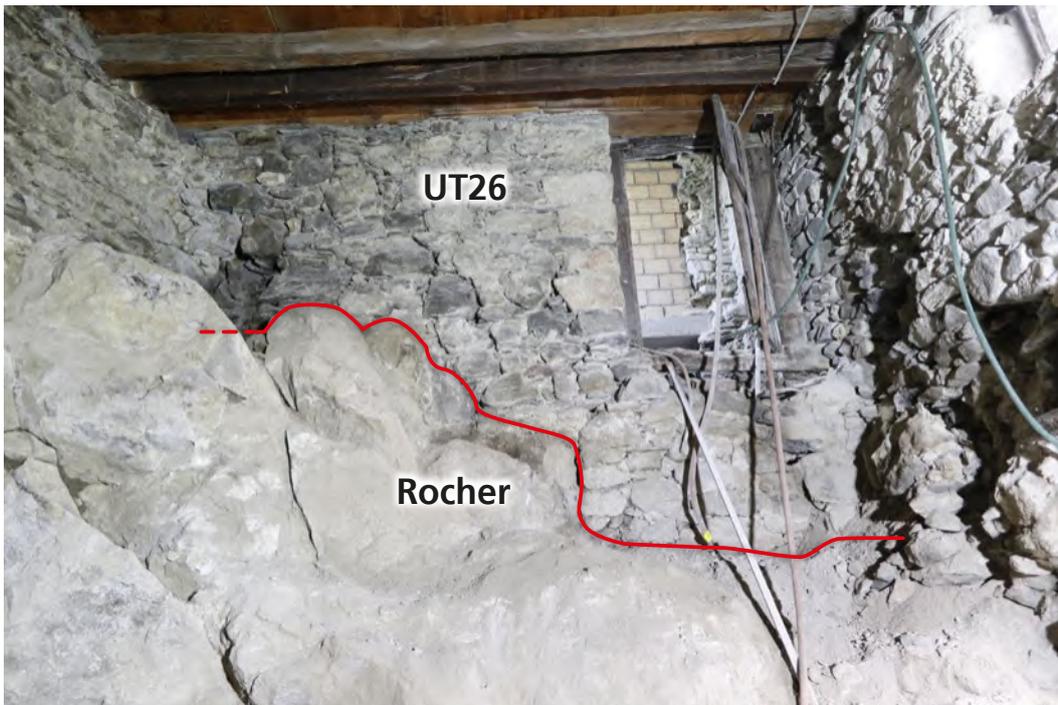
Bâtiment 1. La paroi sud (UT26) du local du local L. 6 est fondée sur le rocher. Vue de l'ouest.
